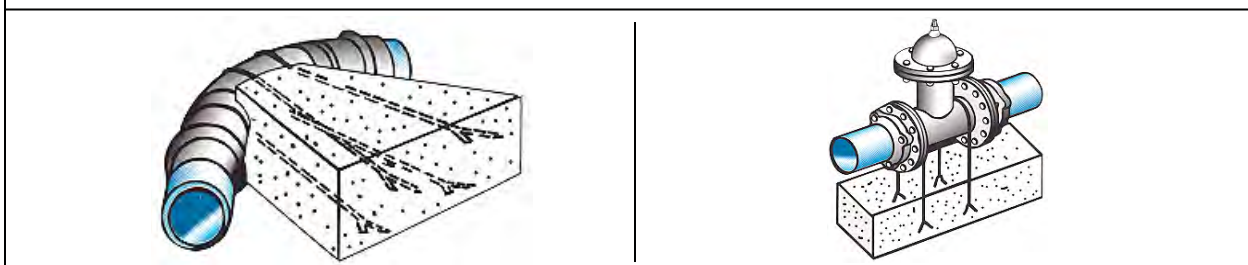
ANCLAJES A MACIZOS DE CONCRETO
